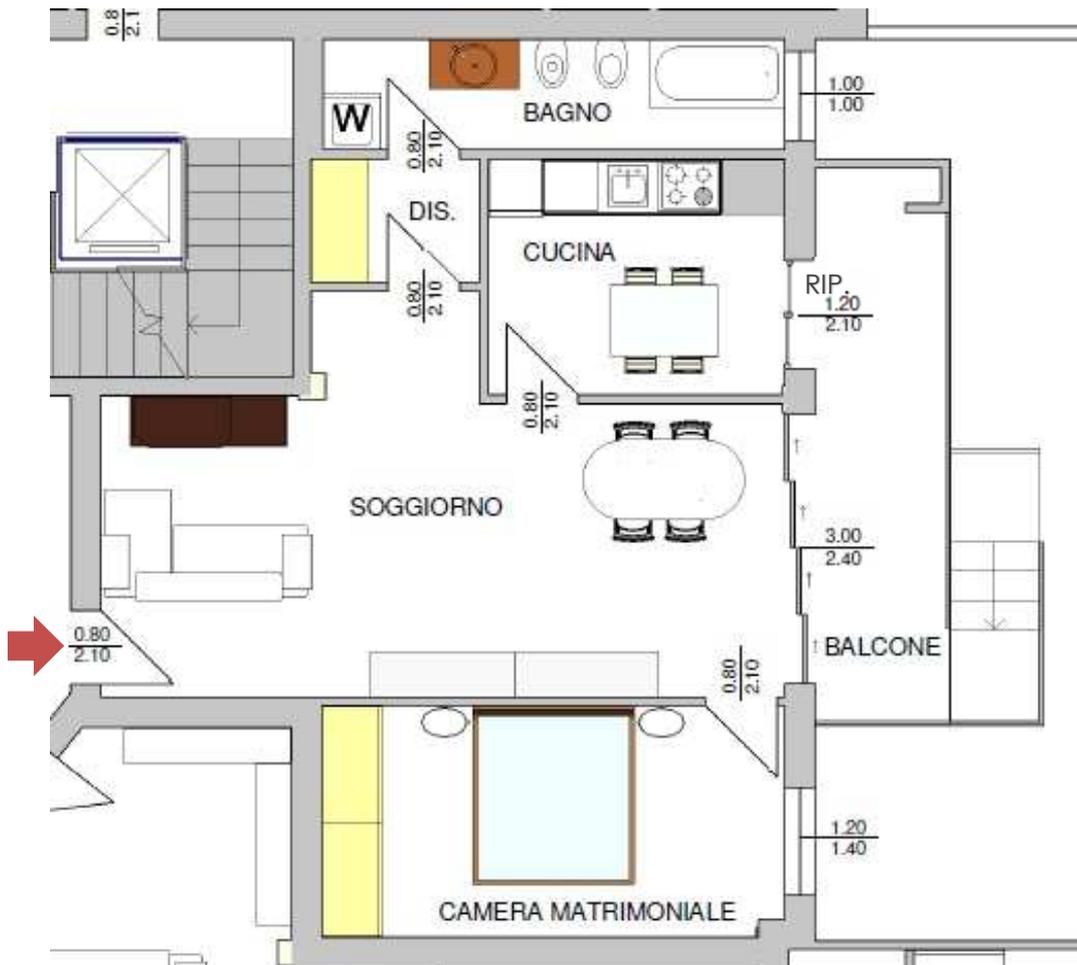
Stralcio pianta piano rialzato – Bilocale tipo 1
